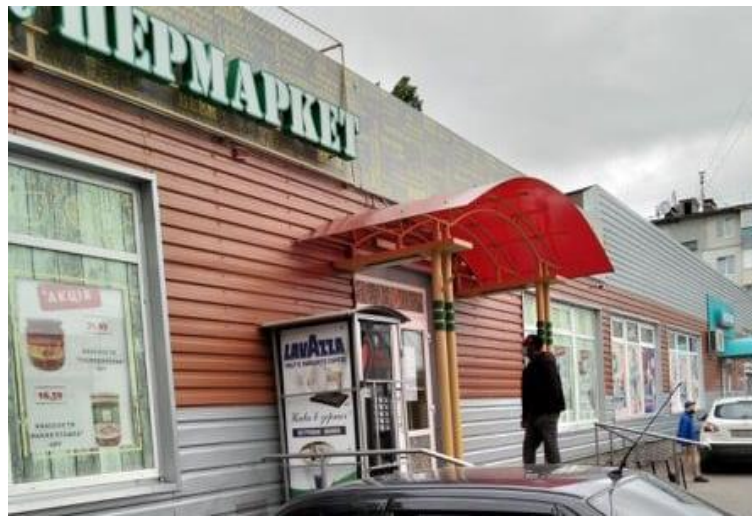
Зовнішній вигляд фасаду будівлі супермаркету
